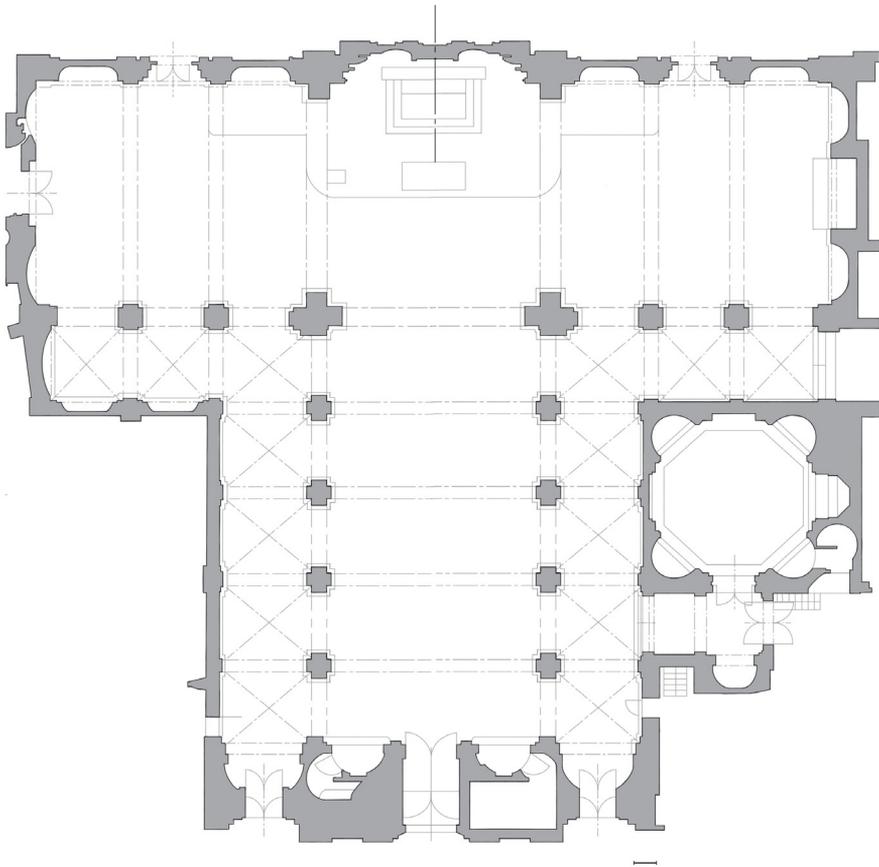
Santa Maria presso San Satiro, planimetria del complesso.
